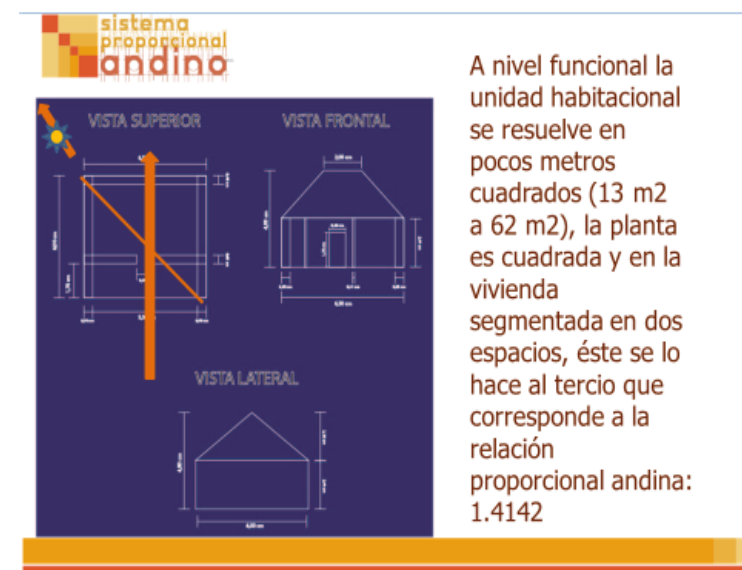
Levantamiento planimétrico de la vivienda. Elaboración la autora.
